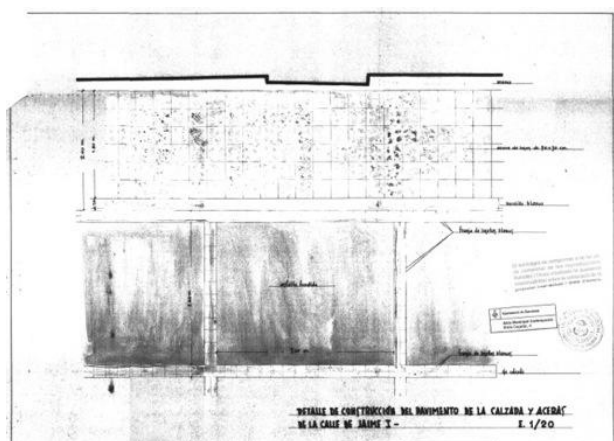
> Detalle de construcción del pavimento de la calzada y aceras de la calle de Jaime I (AMCB 1957)
